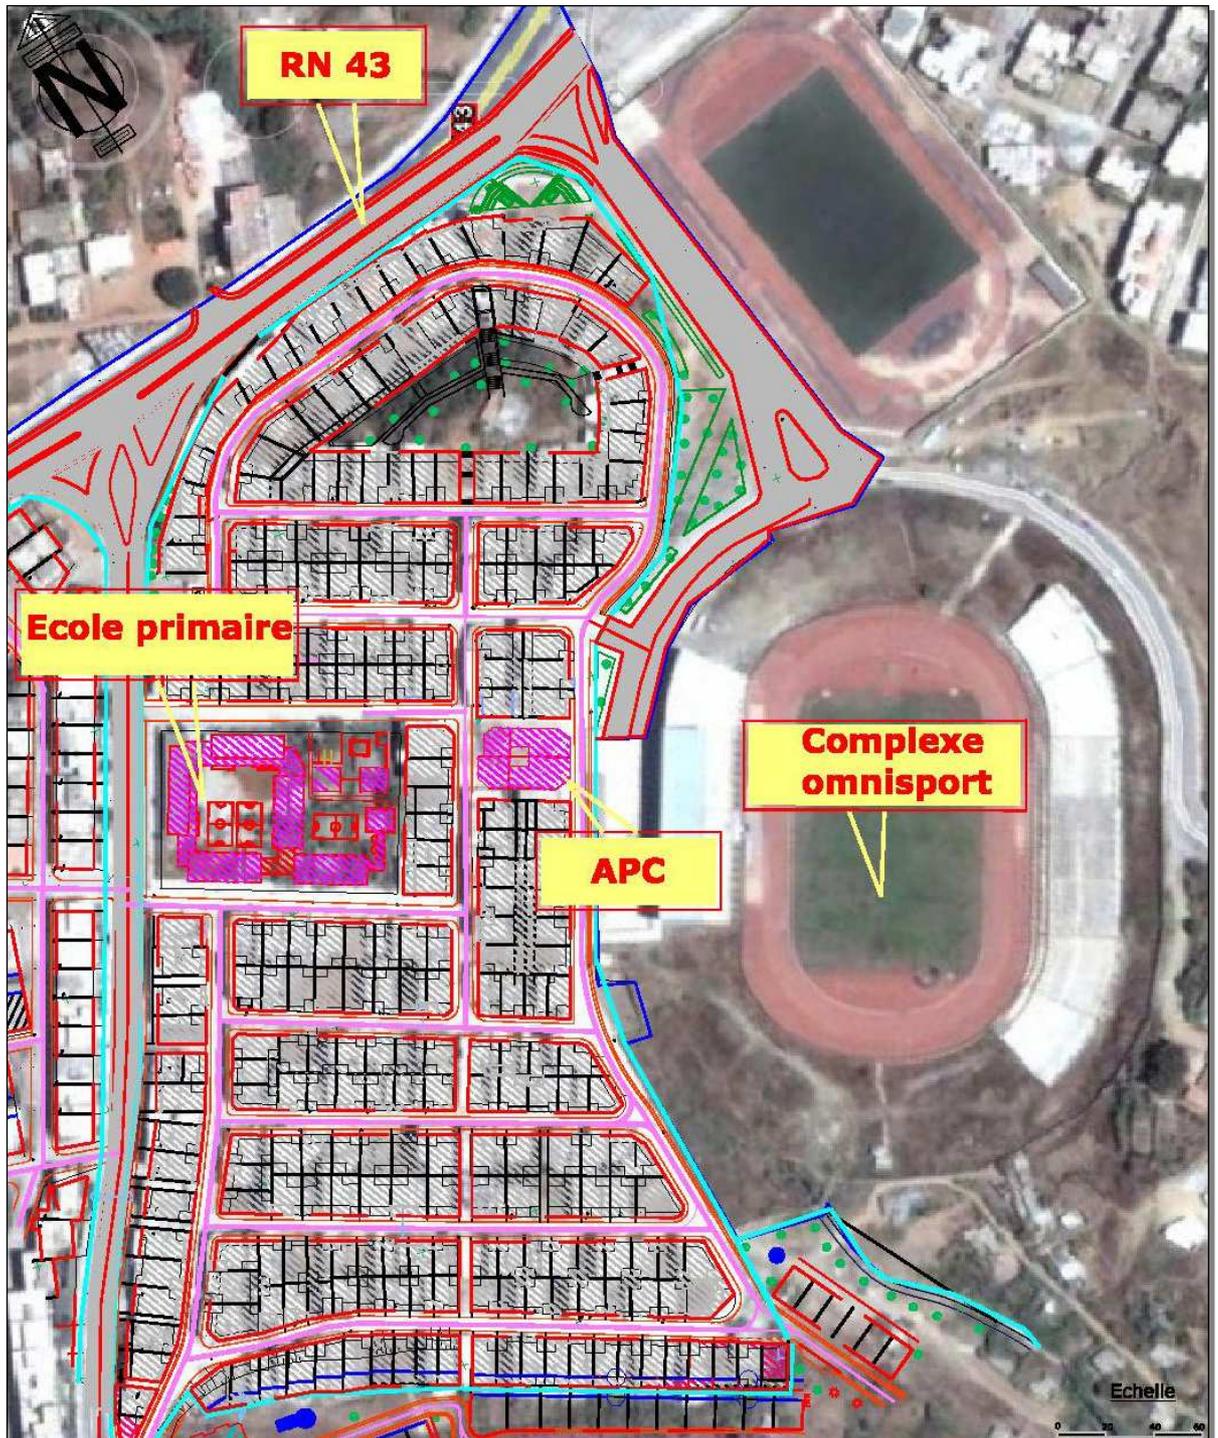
Plan de masse du lotissement Bourmel 04 à Jijel
